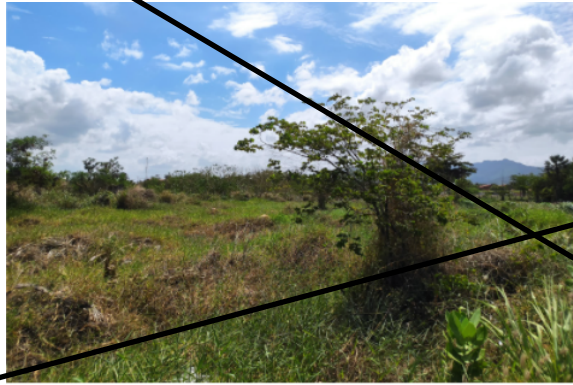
Foto do terreno em estudo. Fonte: retirada do acervo pessoal da autora.
